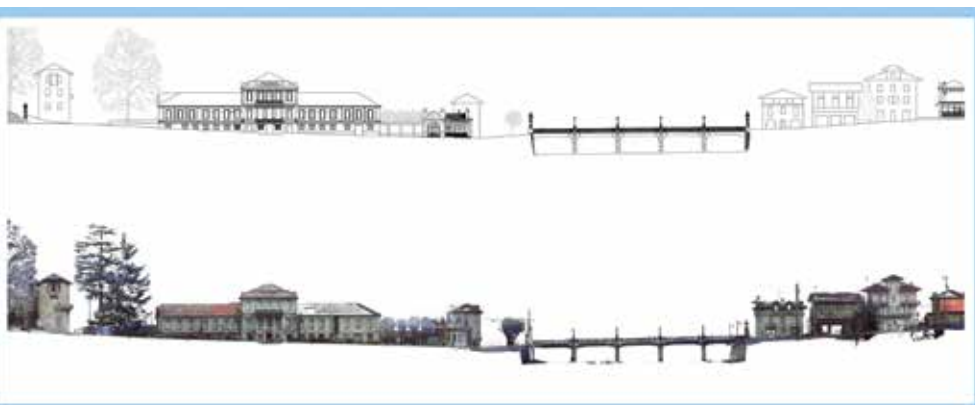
Sezione trasversale al corso del fiume Brembo (restituzione vettoriale e ortofoto).
